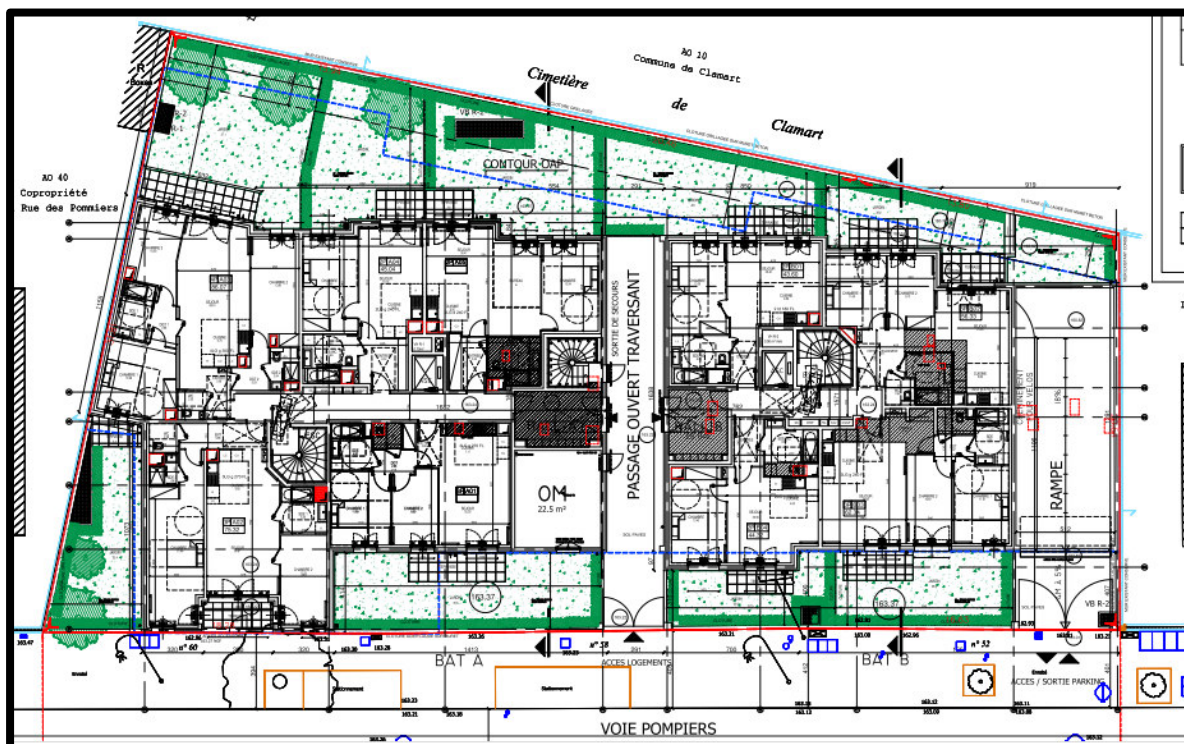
Planta RDC do edifício de estudo (fase projeto)
